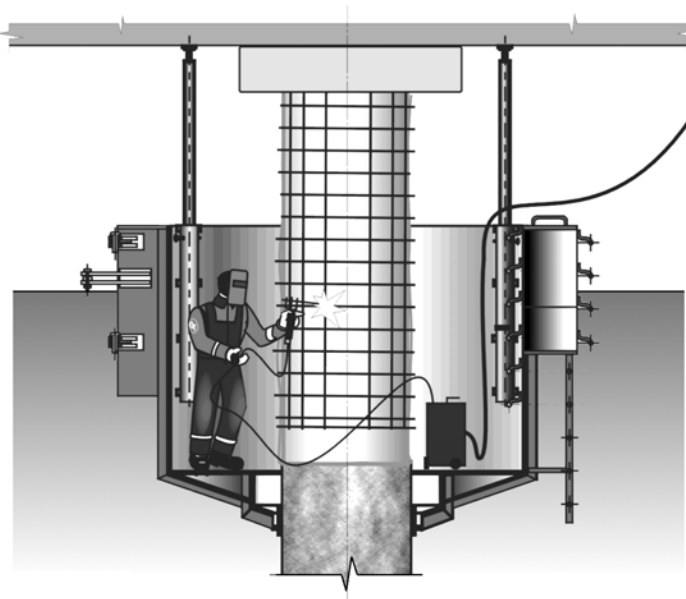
Схема дополнительного армирования железобетонной сваи-оболочки с помощью гермокамеры
